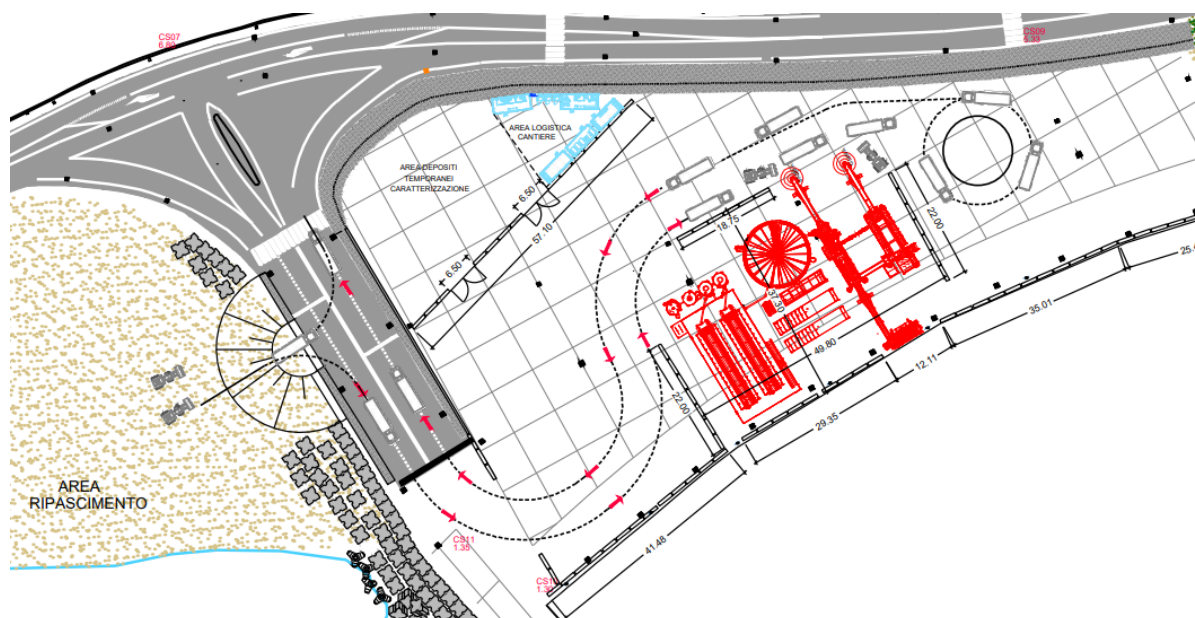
Layout della logistica dell'impianto di Sediment Washing
